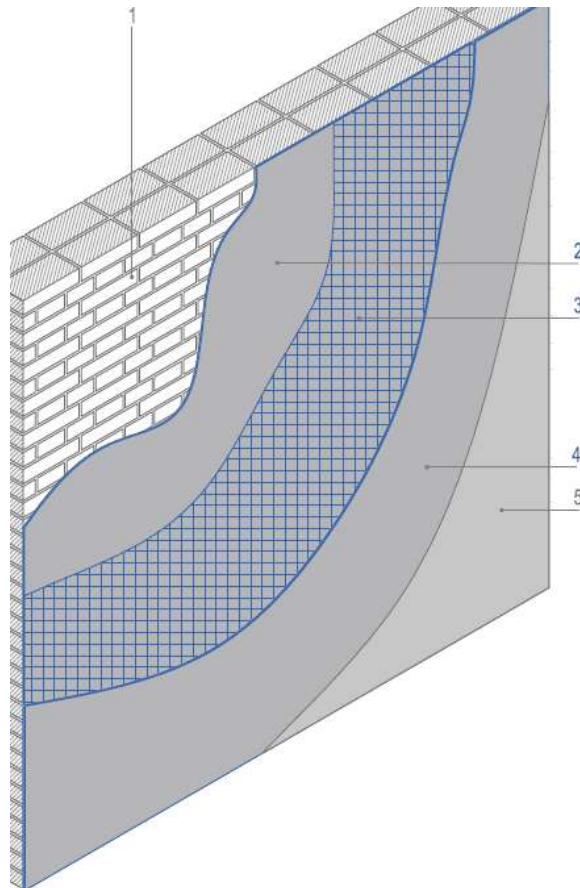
Esquema de la técnica refuerzo frente a acciones fuera del plano y en el plano de fachada con revoques de bajo espesor.
